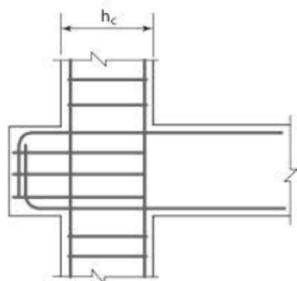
Nœud poteau-poutre de rive – ergot extérieur
